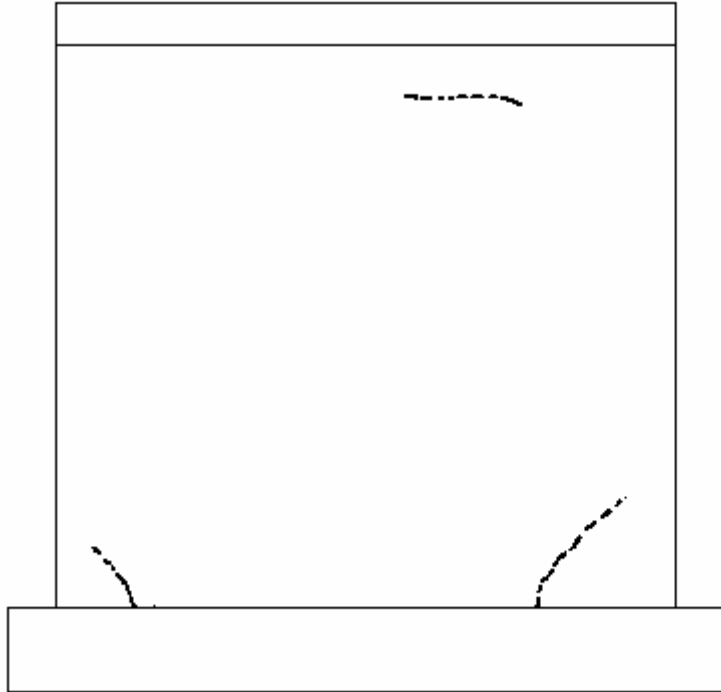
Grietas previas al ensayo del muro MCC50M
